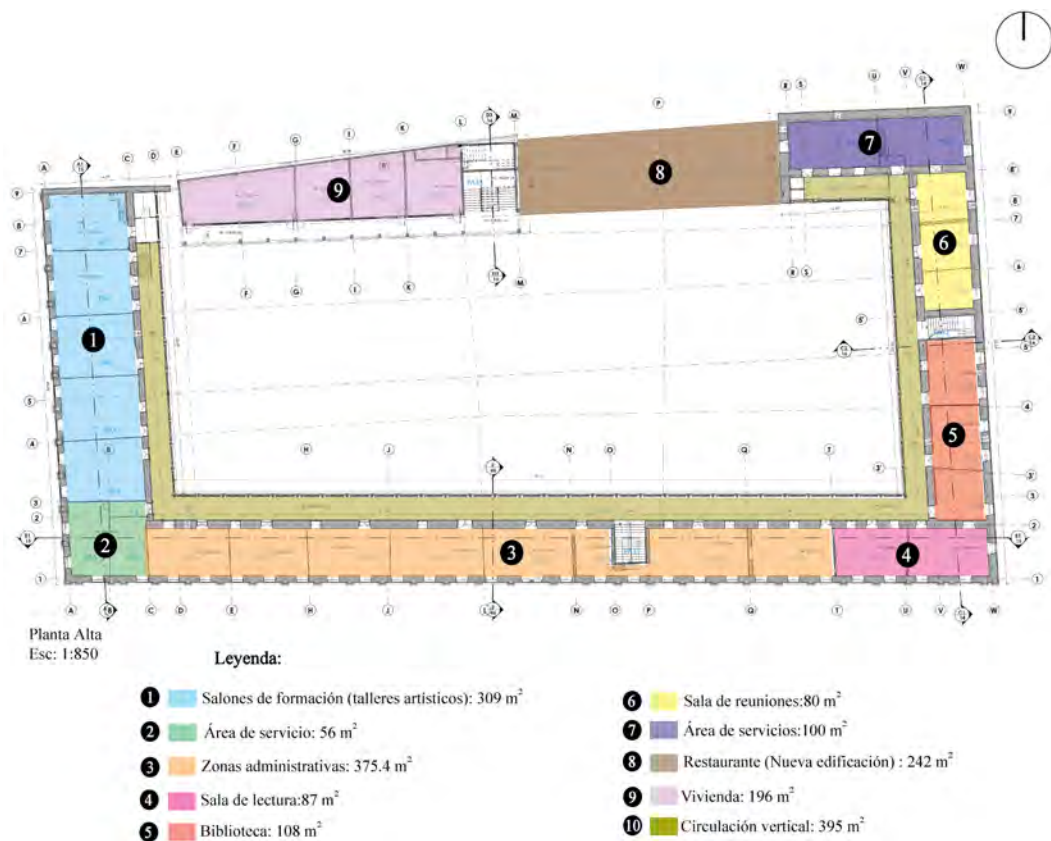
Zonificación específica de planta alta arquitectónica. Fuente y elaboración: propia.
